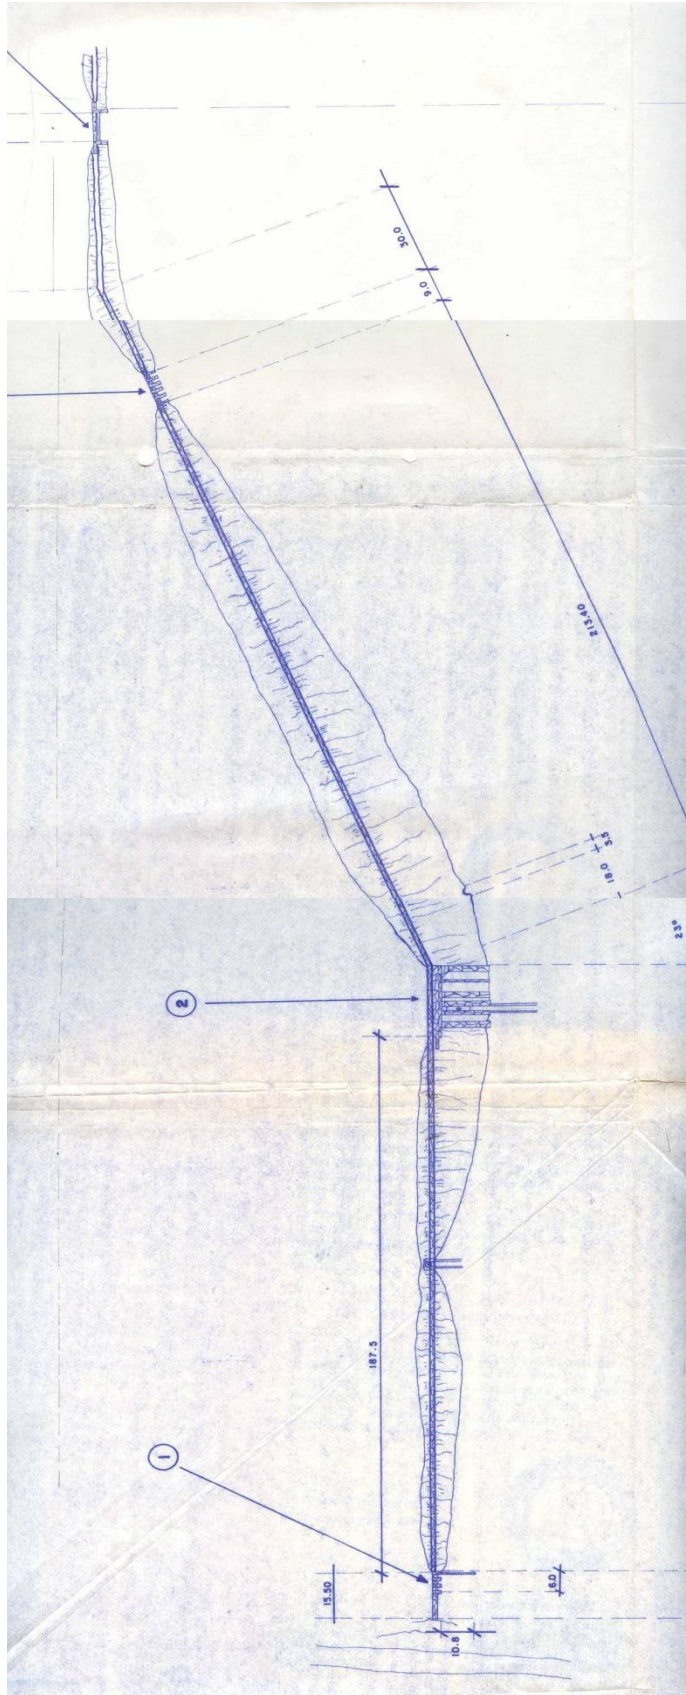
Proyección en planta de la cortina de la presa El Capulín
